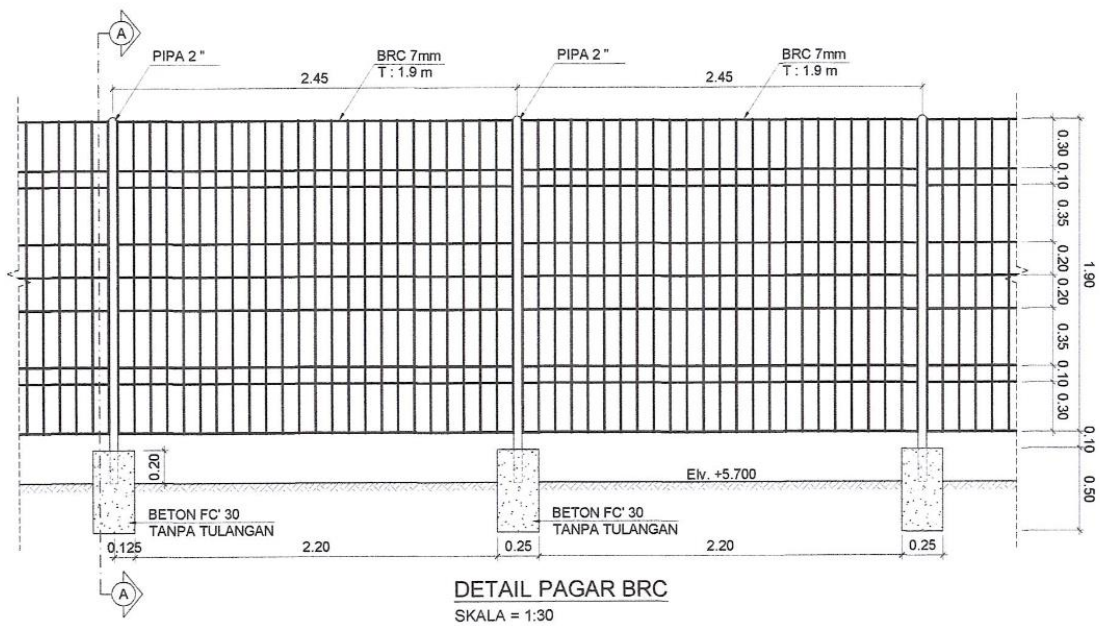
13 Layout Rencana Pemasangan Pagor BRC Tipe 190 Untuk KM 105+500 – KM 105+600 dan KM 105+614 – KM 105+663
